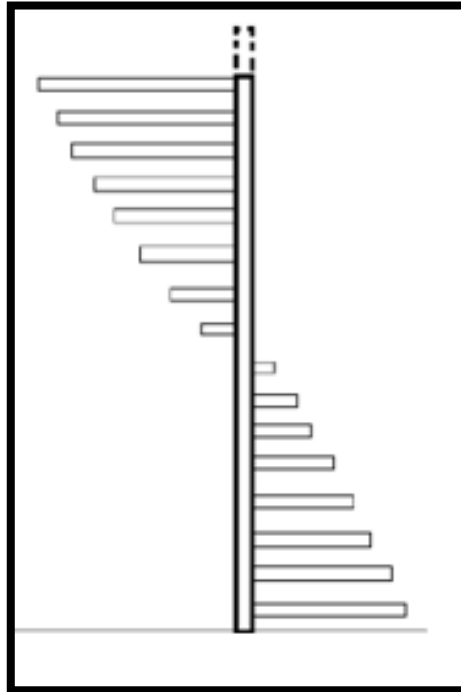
Vista en perfil de escalera helicoidal con apoyo central. Morales (2010).
